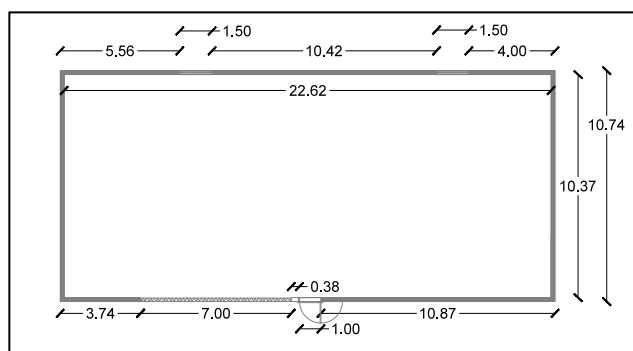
Planta de rés-do-chão do edifício de obra de entrada
